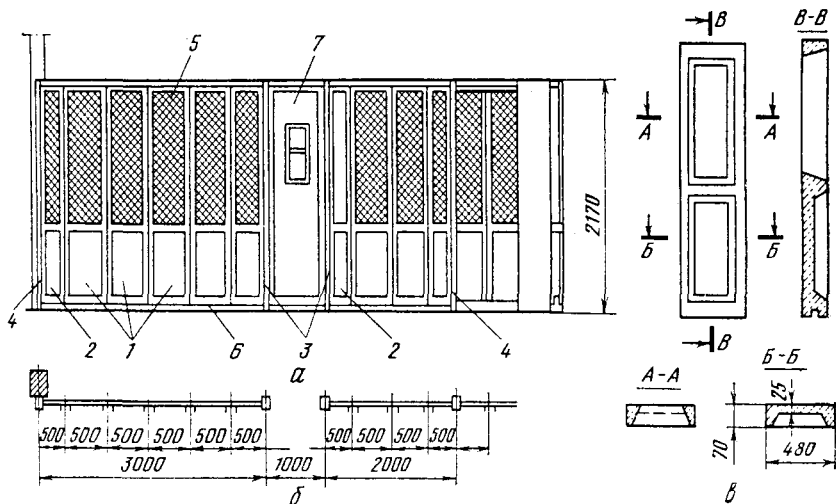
Сборно-разборная перегородка из железобетонных панелей:
